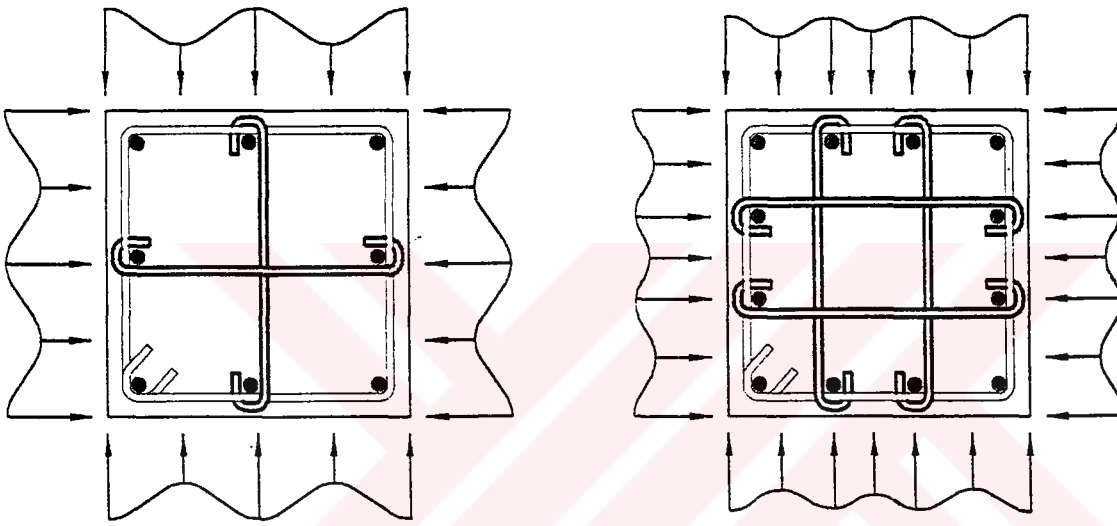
Kolon çekirdek betonun kısıtlanması için etriye yerleştirme biçimleri (Bayülke, 1998)
